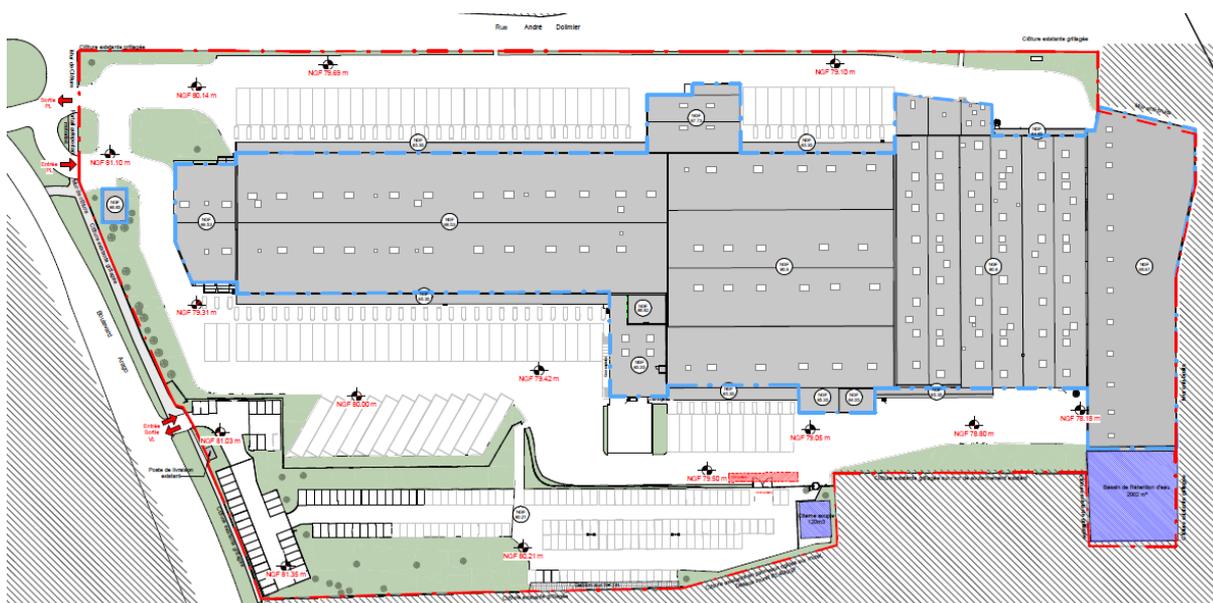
Plan de masse du site industriel existant – source : REID BREWIN ARCHITECTES
